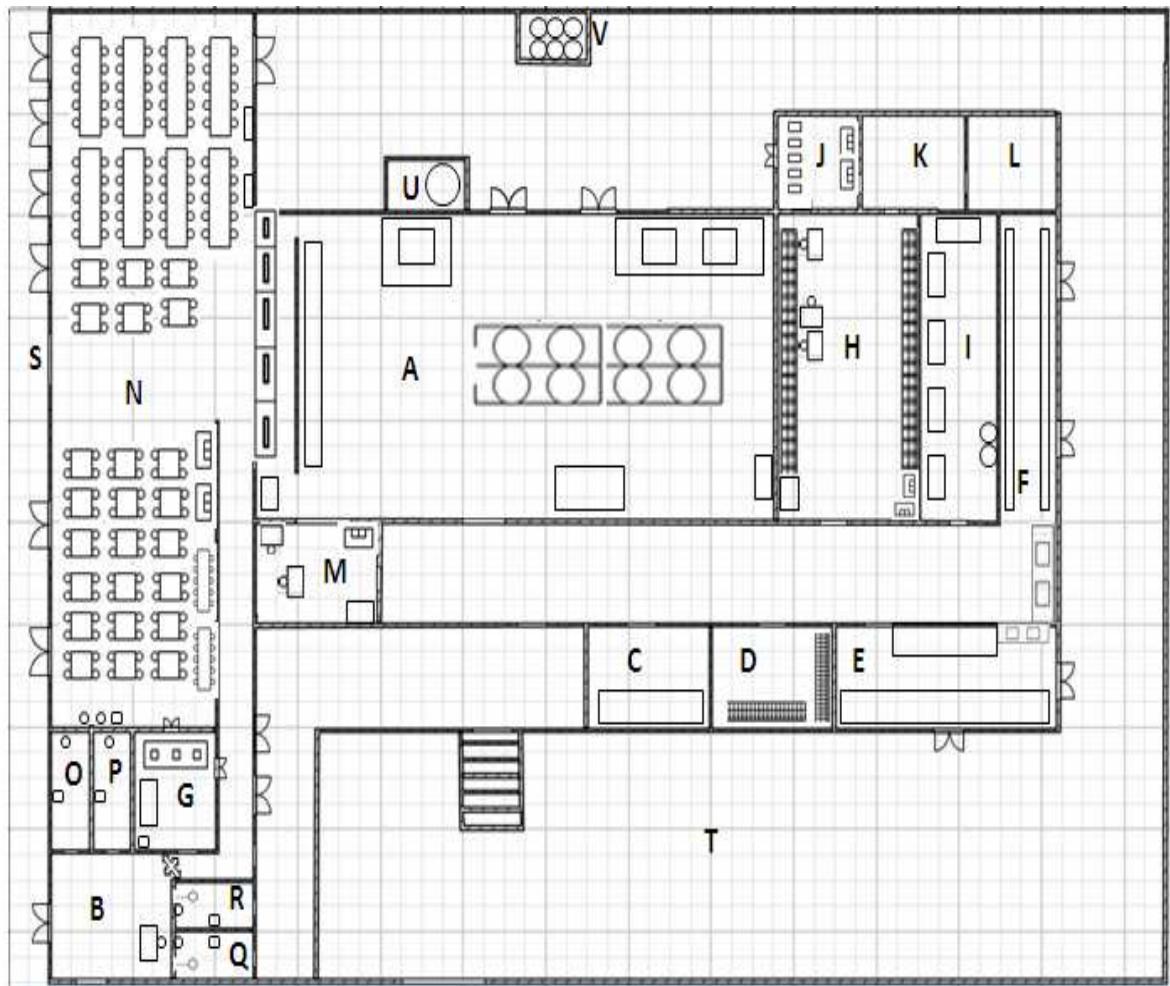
Planta Baixa do Restaurante Institucional (UAN 3)
